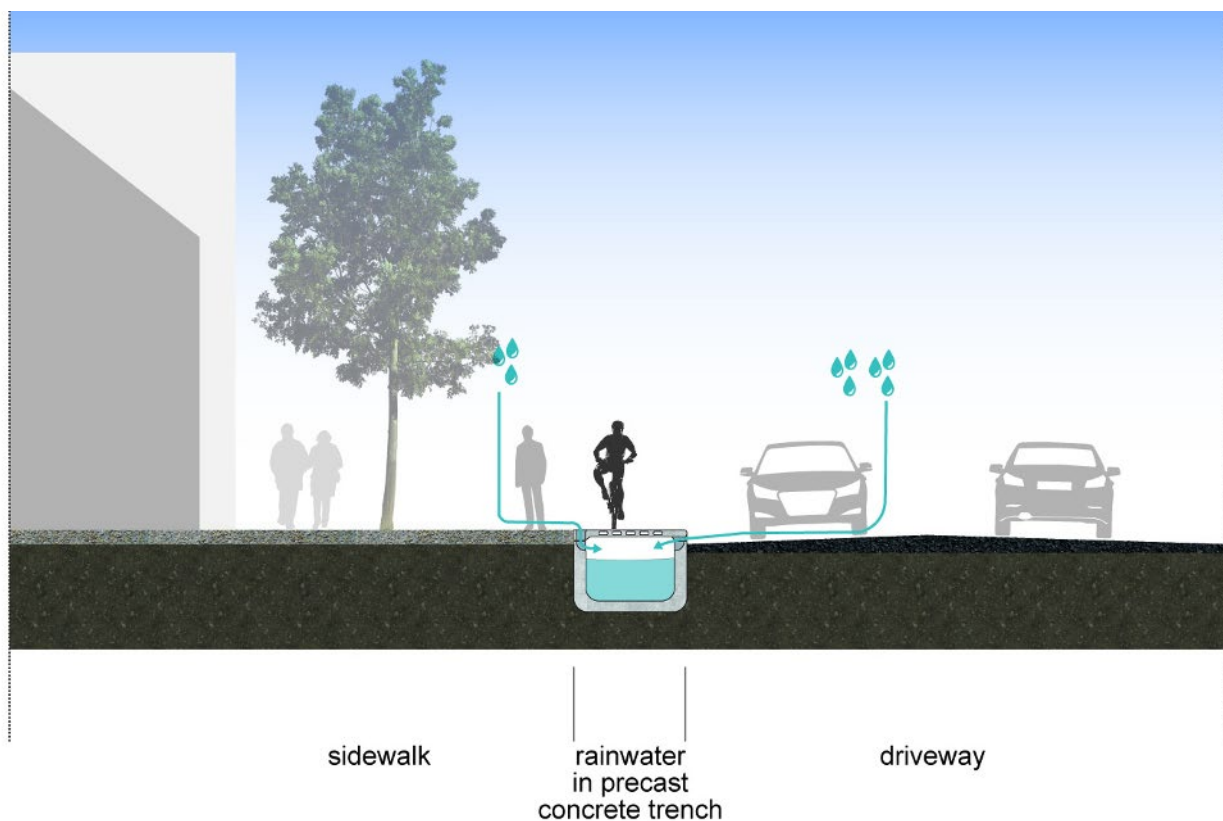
The Copenhagenize Current è il progetto di un canale prefabbricato al di sotto della pista ciclabile di M. Colville-Andersen e S. Montebello. Fonte: disegno originale dell'arch. M. Padrone.
